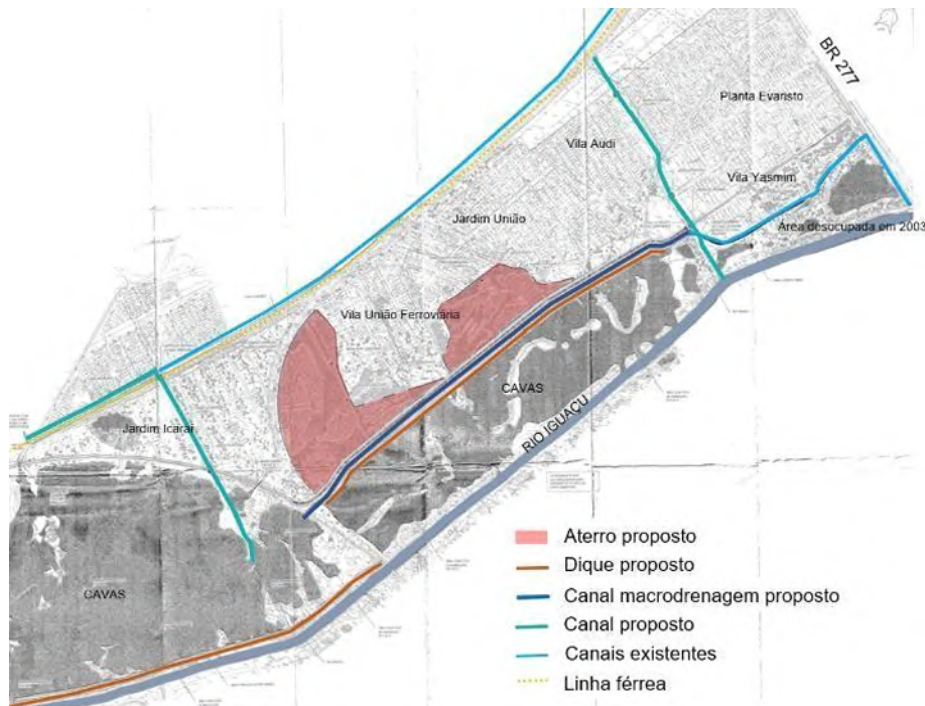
Síntese das Obras de Drenagem no Bolsão Audi União
